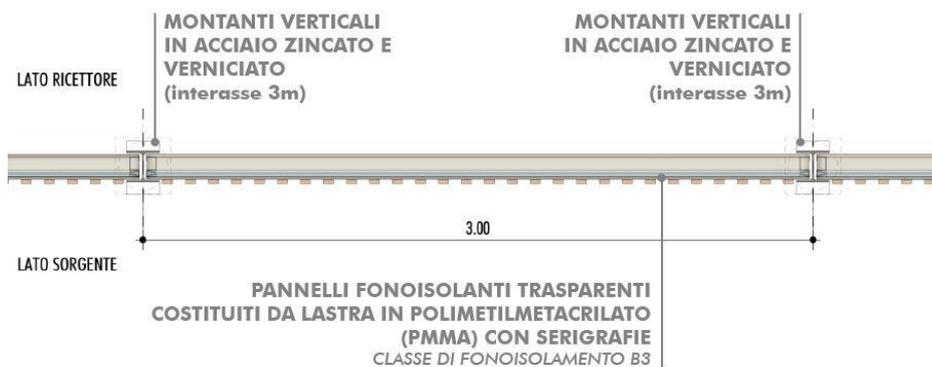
SEZIONE ORIZZONTALE – PANNELLO TRASPARENTE
